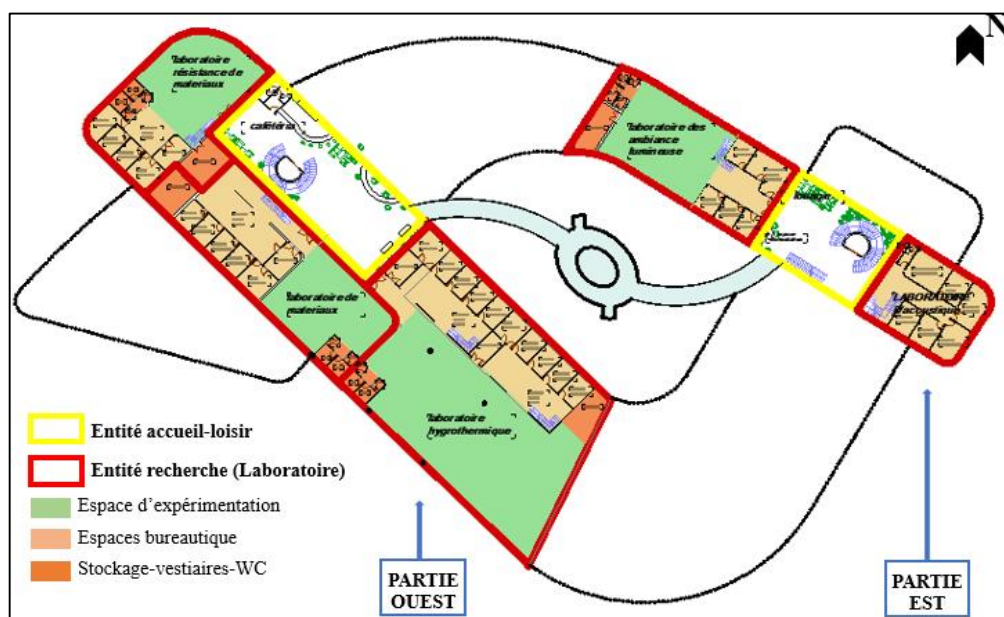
Plan 1^{er} Étage +06.00 Source : Auteur
